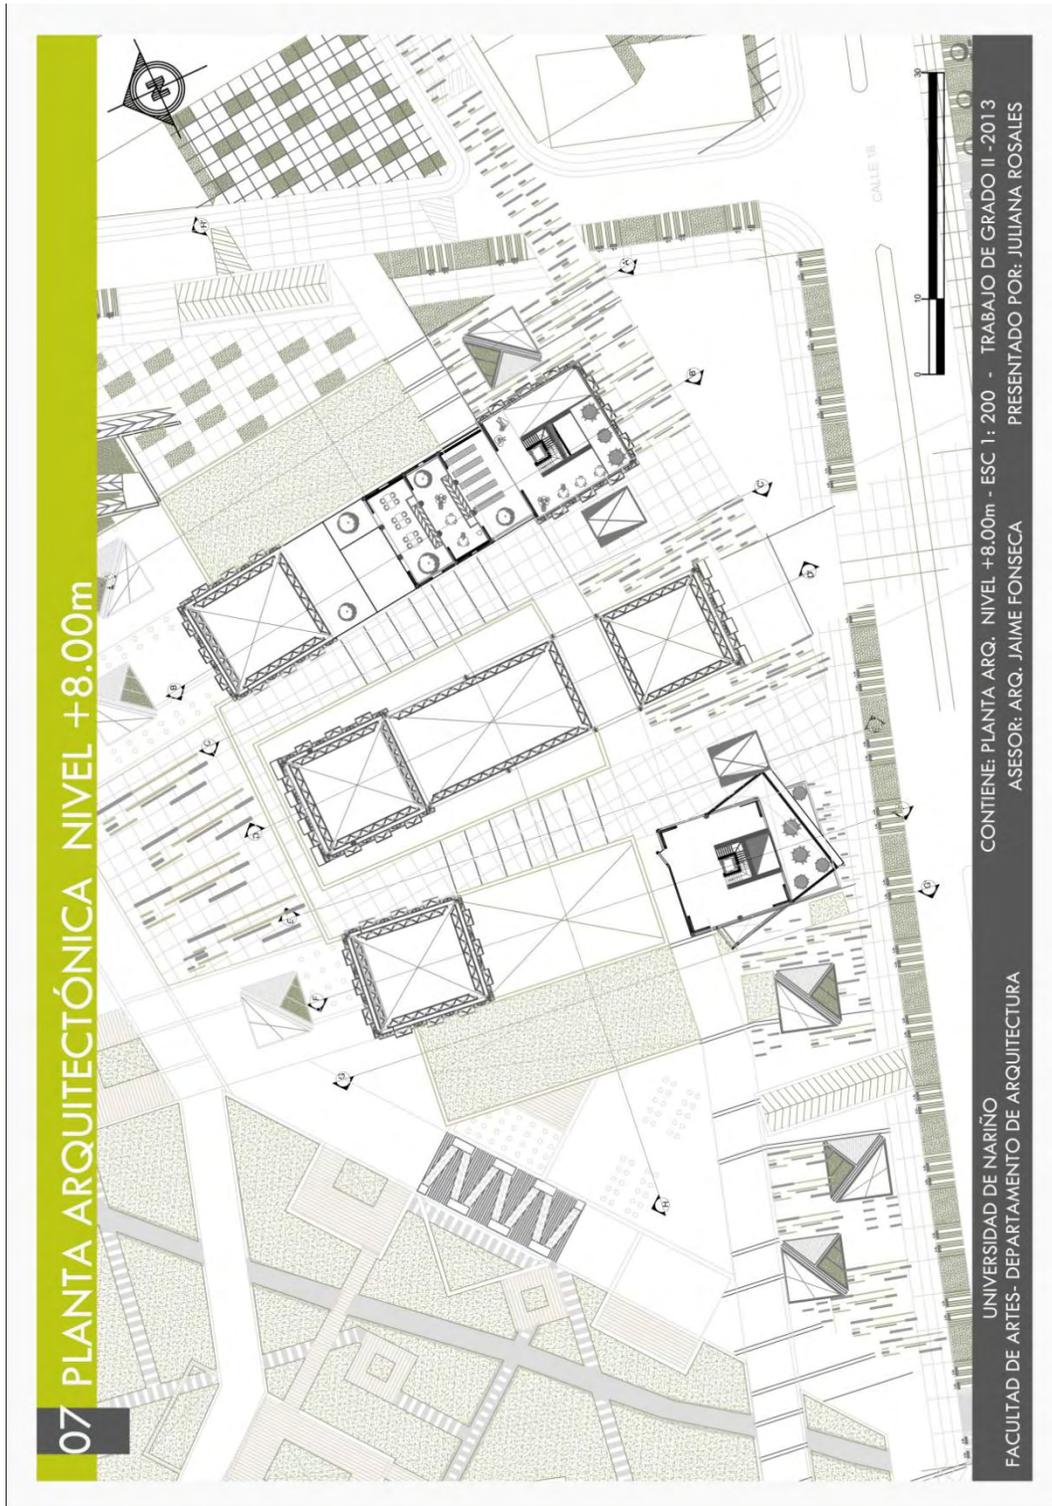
Planta nive +8.00m // Fuente esta investigación
